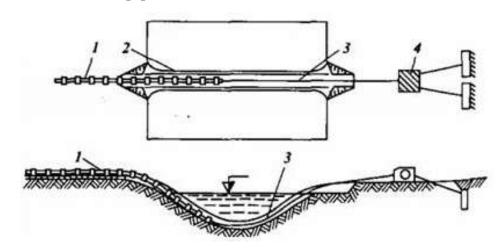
Схема укладки способом протаскивания 1-трубопровод; 2-траншея; 3-трос; 4-лебедка.
